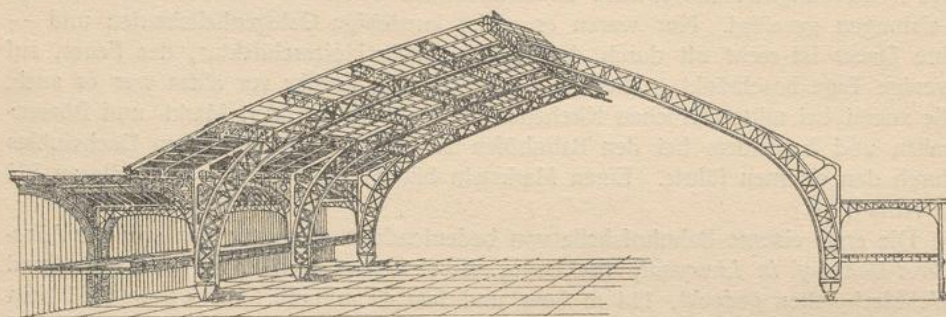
Hallenbau der Pariser Maschinenhalle auf der Ausstellung von 1889.
